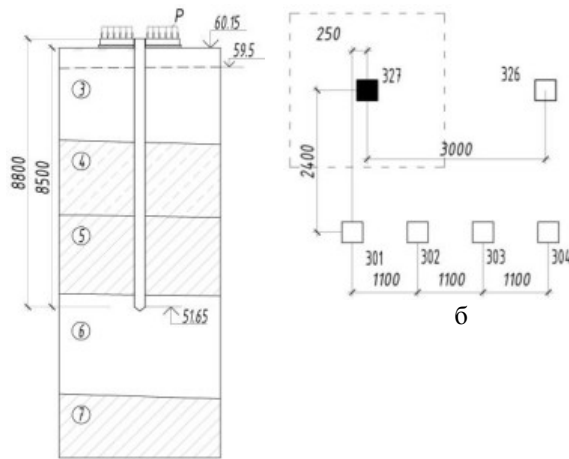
Схема розташування палей в плані (б) та переріз для моделювання навантаження палі та фрагменту ростверку(б):  $p$  – навантаження на фрагмент плити ростверку. / The layout of the piles in the plan and the cross section for modeling the load of the pile and the plates' fragment in the Plaxis 3D:  $p$  - the load on the fragment of the plate s' raft
